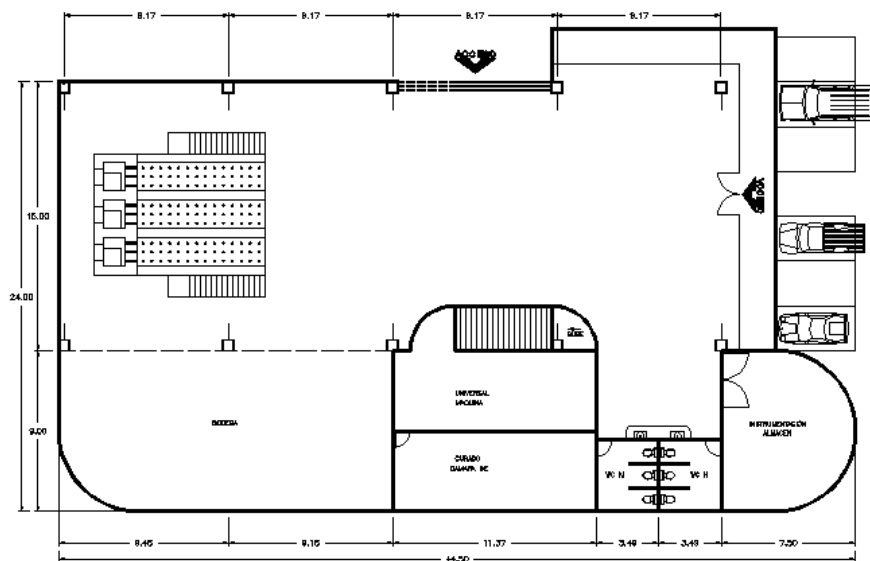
Planta baja del proyecto arquitectónico del Laboratorio de Estructuras
